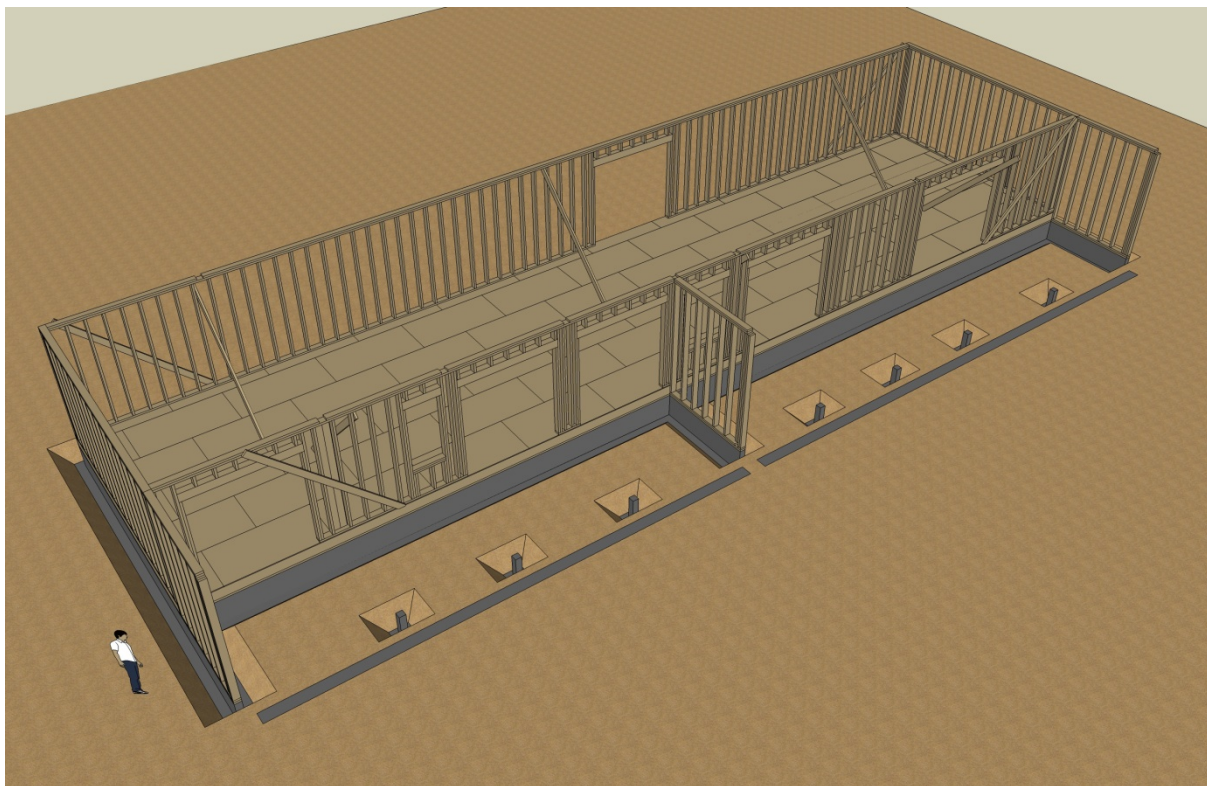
Montagem das paredes exteriores (de topo) ao pavimento e às paredes exteriores longitudinais.
